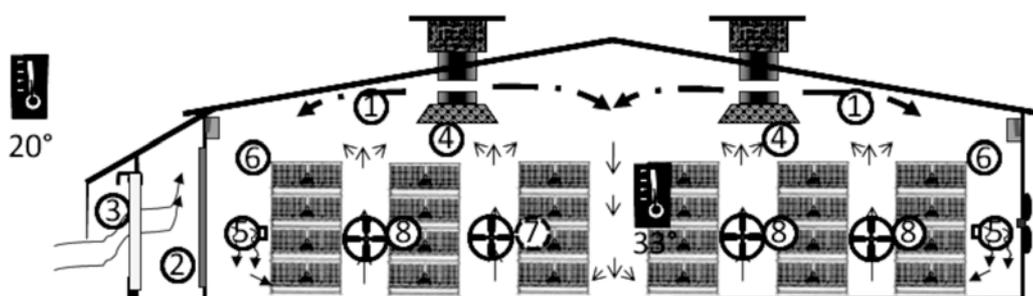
Installation avec entrée d'air toit (Fumus)
